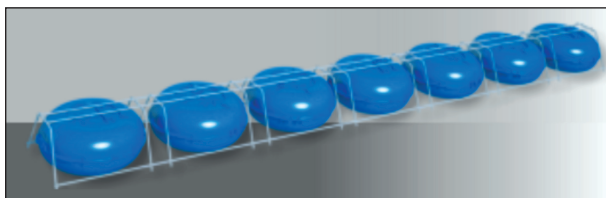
SL mit abgeflachten Hohlkörpern für besonders schlanke Betondecken [42]
